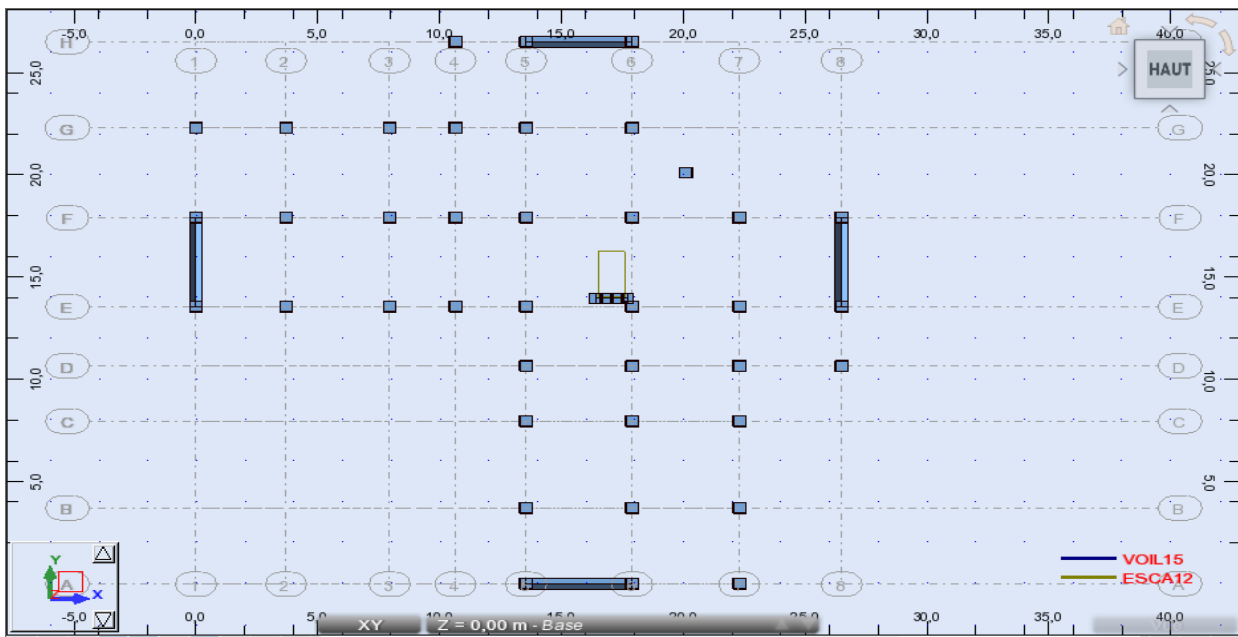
La 2ème disposition des murs voiles et poteaux
